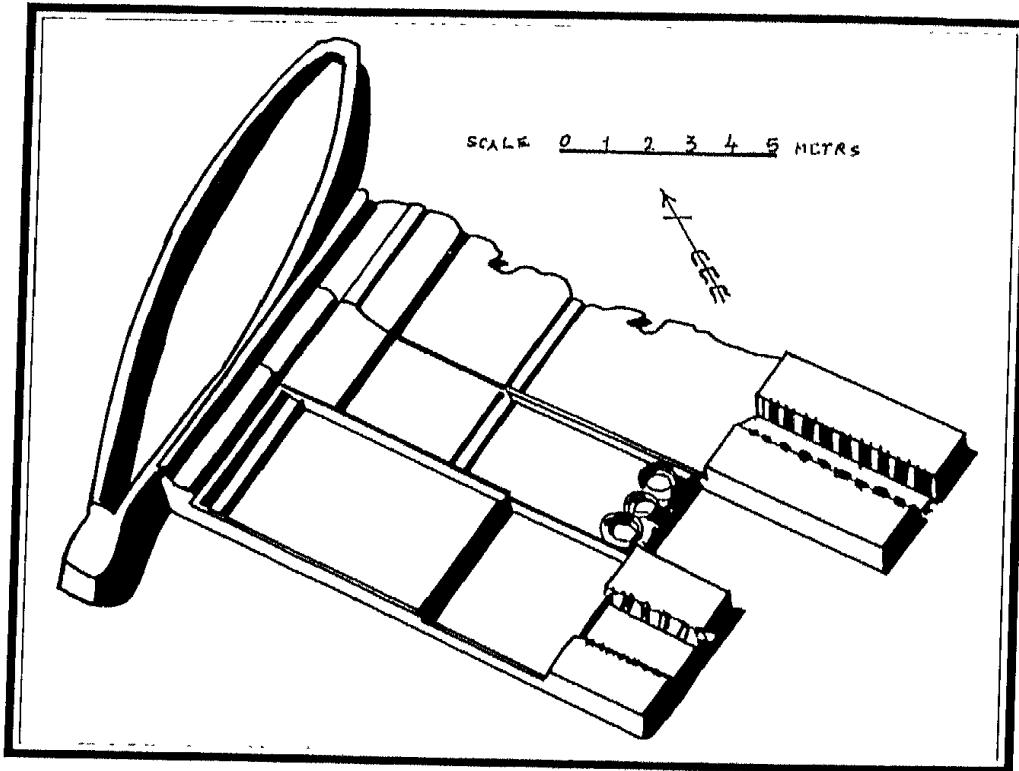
مسقط أفقى للمقبرة ٣٣٥٨ في سقارة.
